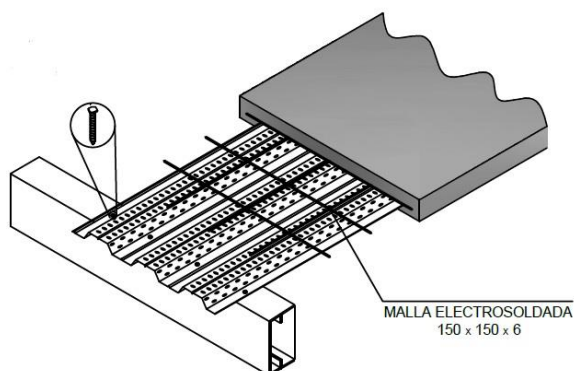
Detalle constructivo y Disposición de malla electrosoldada
